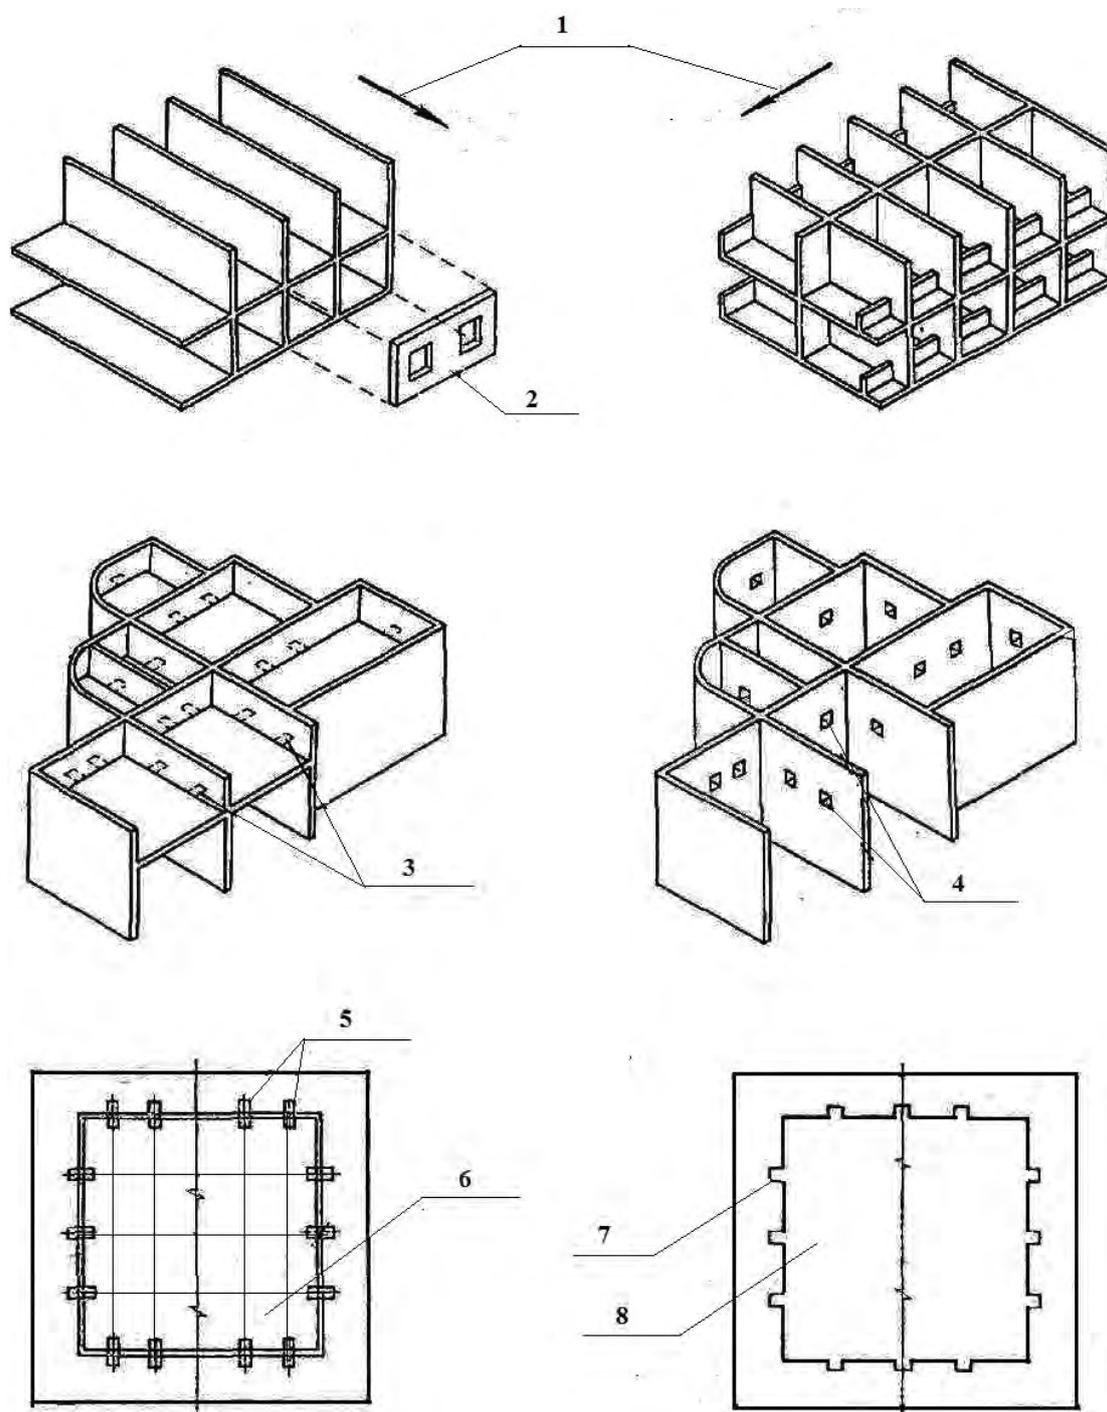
Монолитная объемно-переставная опалубка: 1 — движение опалубки; 2 — сборная наружная стенная панель; 3 — опорные выступы; 4 — отверстия для опорных выступов; 5 — опорные арматурные каркасы; 6 — сборное перекрытие; 7 — опорный выступ перекрытия; 8 — монолитное перекрытие
